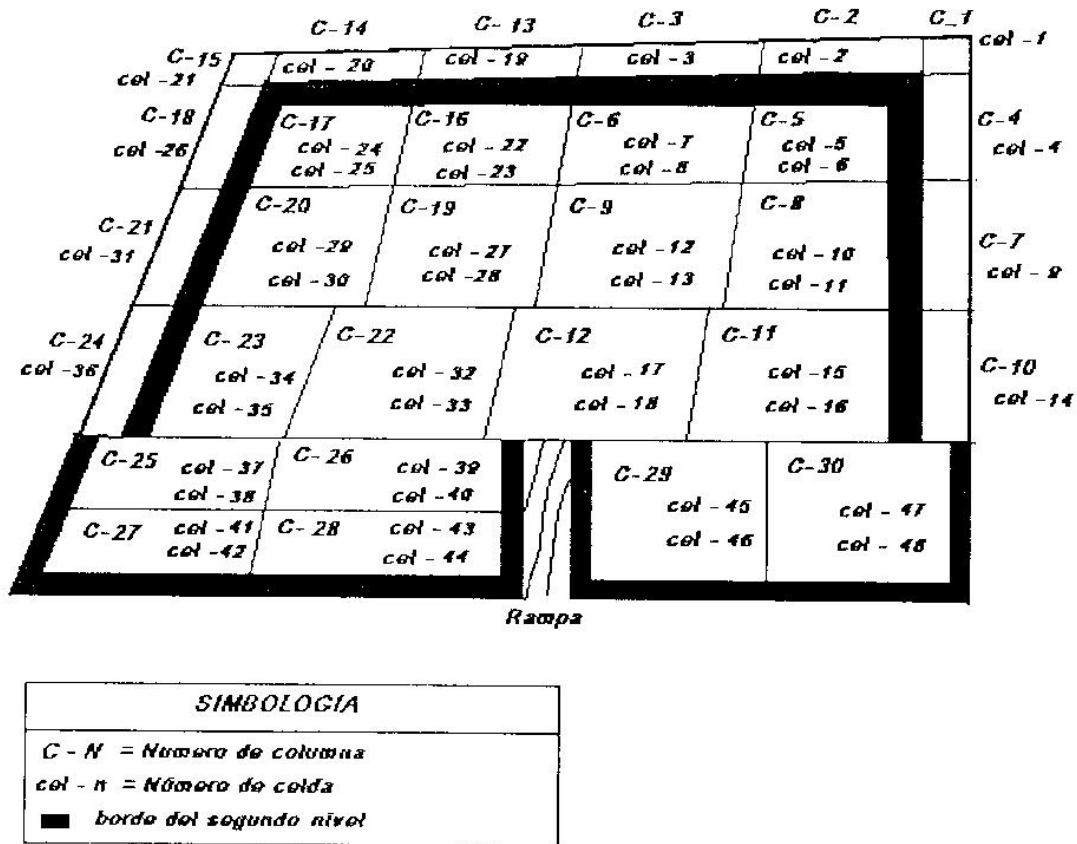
Numeración de columnas y celdas de basuras, considerando la discretización.
